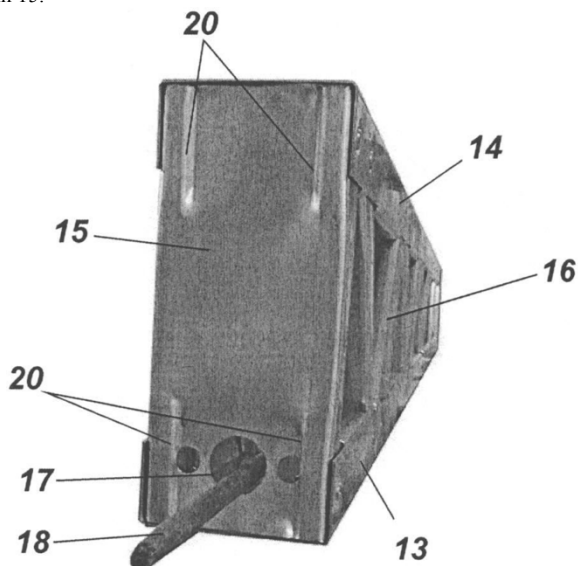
Пространственная ферма, вид спереди сверху, в сборе [4], где: 13 – нижний пояс; 14 – верхний пояс; 15 – соединительные стойки; 16 – соединительные раскосы; 17 – отверстия для дополнительной арматуры; 19 – отверстия для пропуска бетона.
